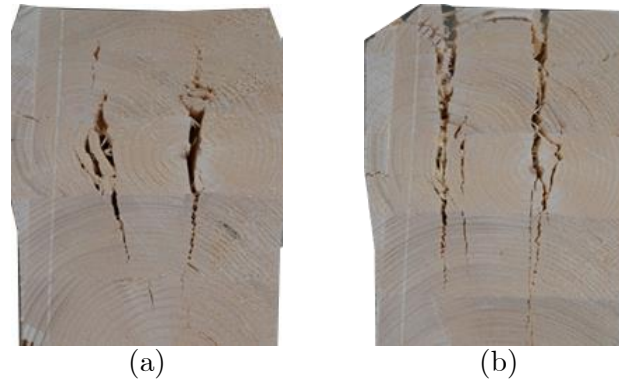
Fissuration au droit des vis de renforcement
